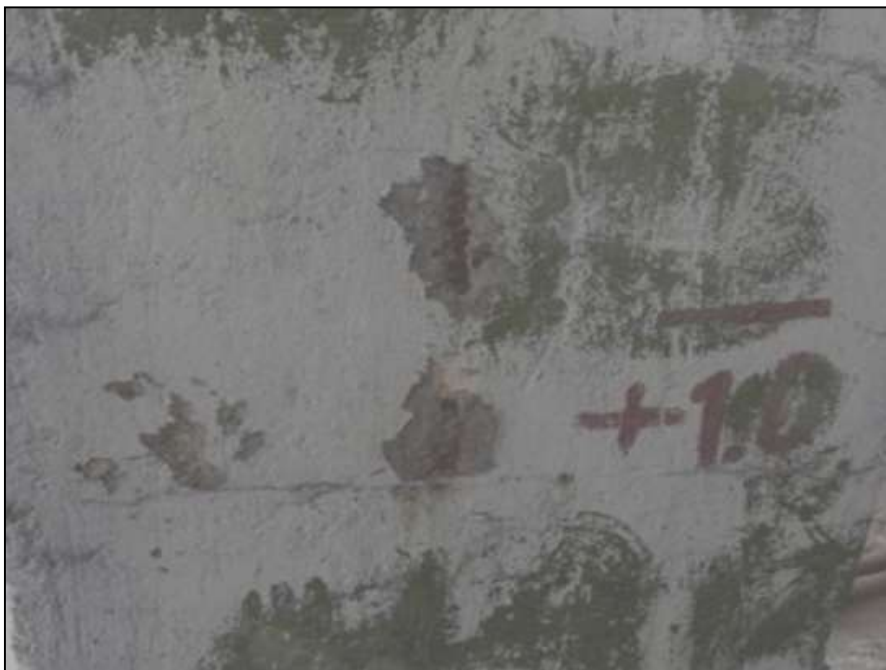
Колонна в осях «А/1». Разрушение защитного слоя бетона с оголением и коррозией арматуры. Усадочные трещины вдоль арматурных каркасов.
